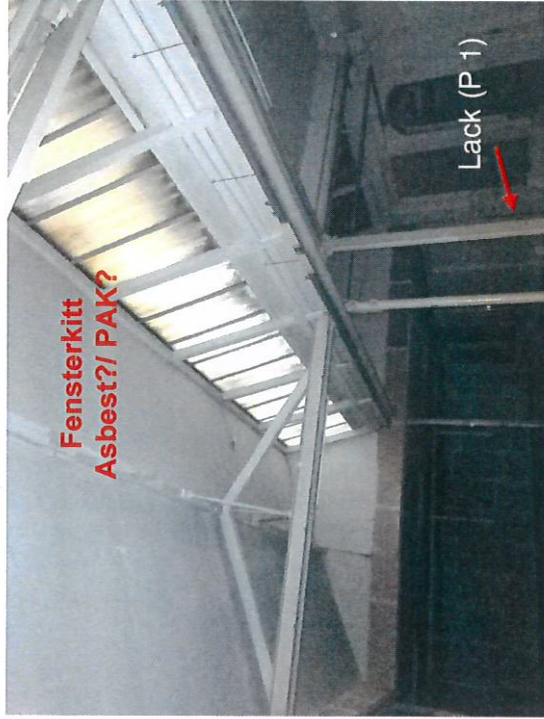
Rohwarenlager mit Drahtgitterglas-Lichtbändern
